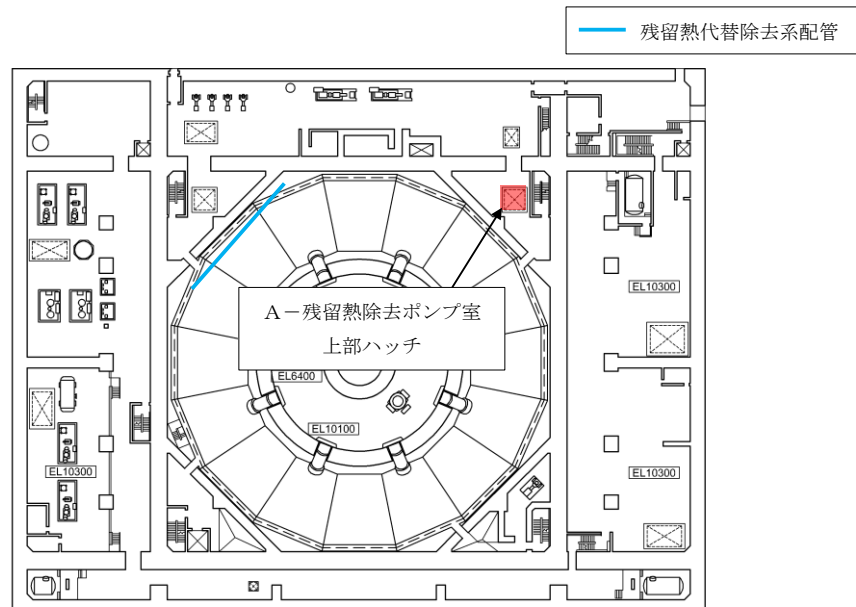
機器配置図 (原子炉建物地下1階) (2 / 2)
